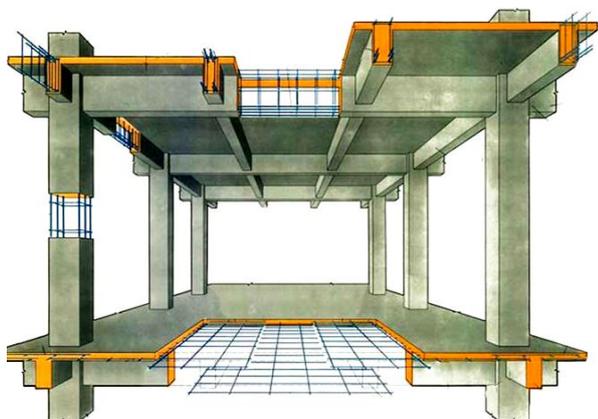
Конструкция балочной монолитной плиты перекрытия.
